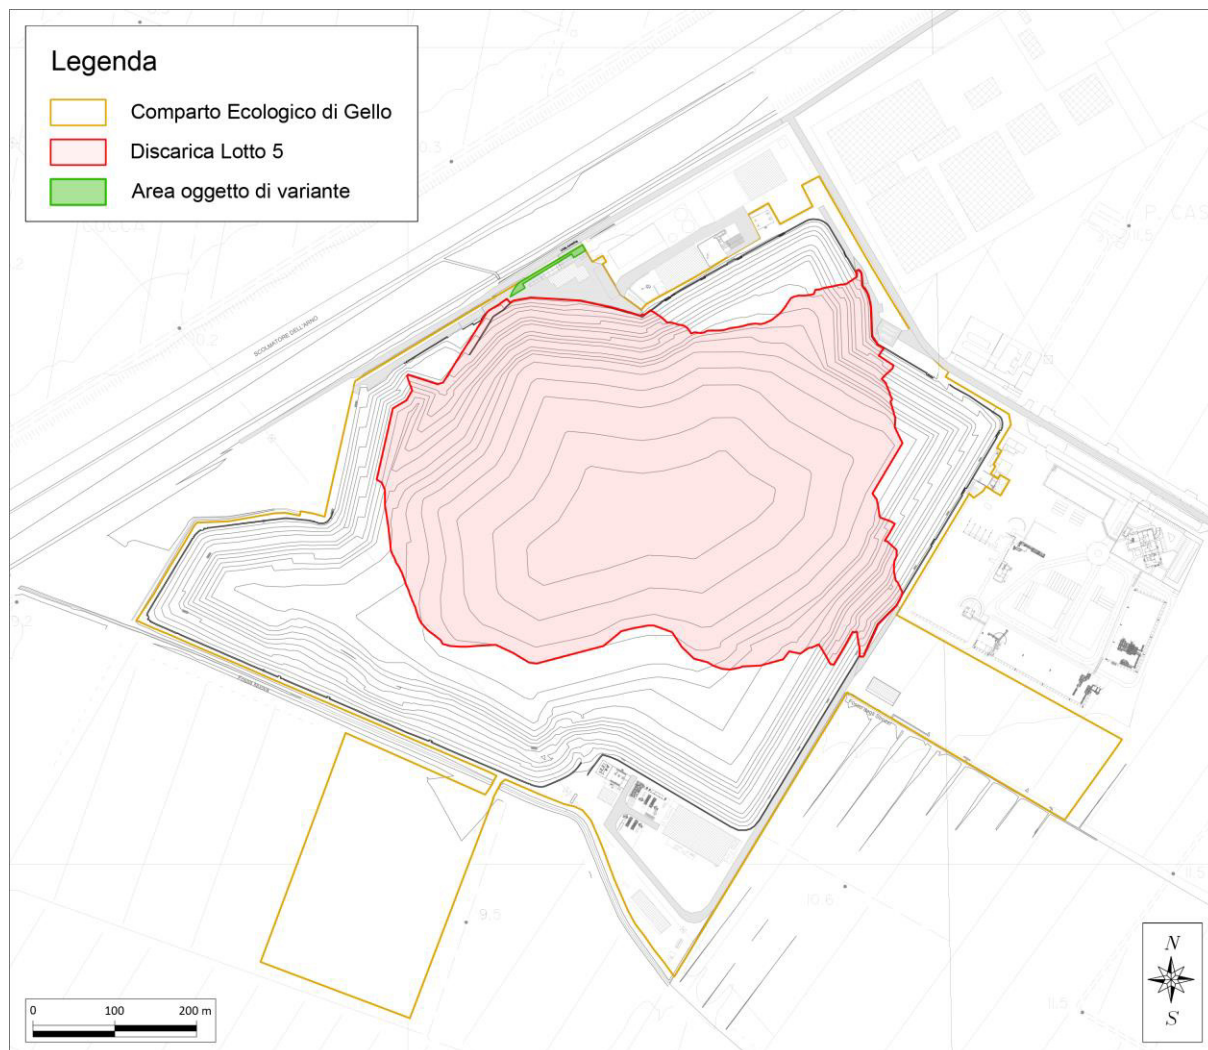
1 - Ubicazione area oggetto di variante progetto LOTTO 5
